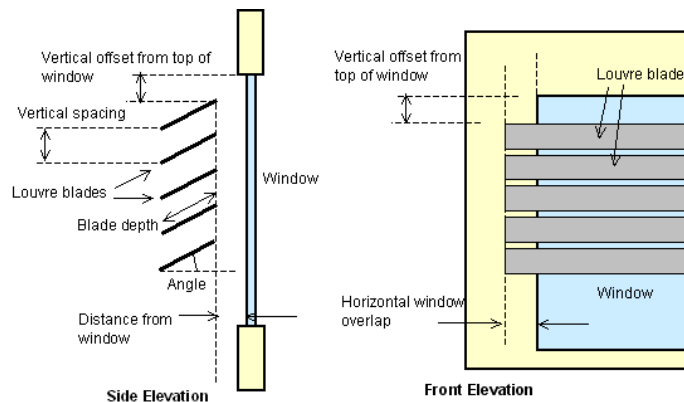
Parámetros para el diseño de quebravistas en Design Builder [17]
